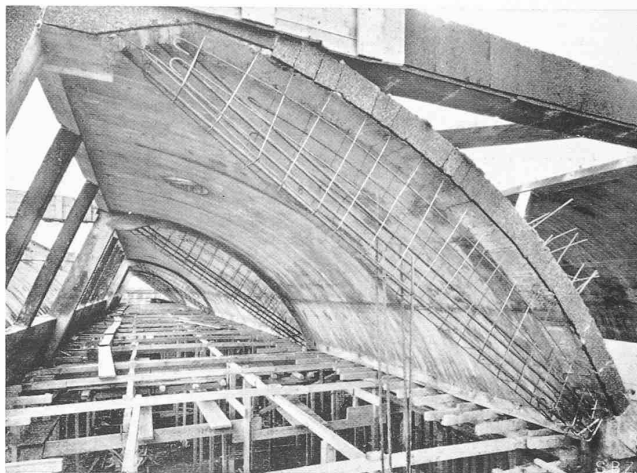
Gezogene Fachwerkstäbe, vor ihrer Betonierung
